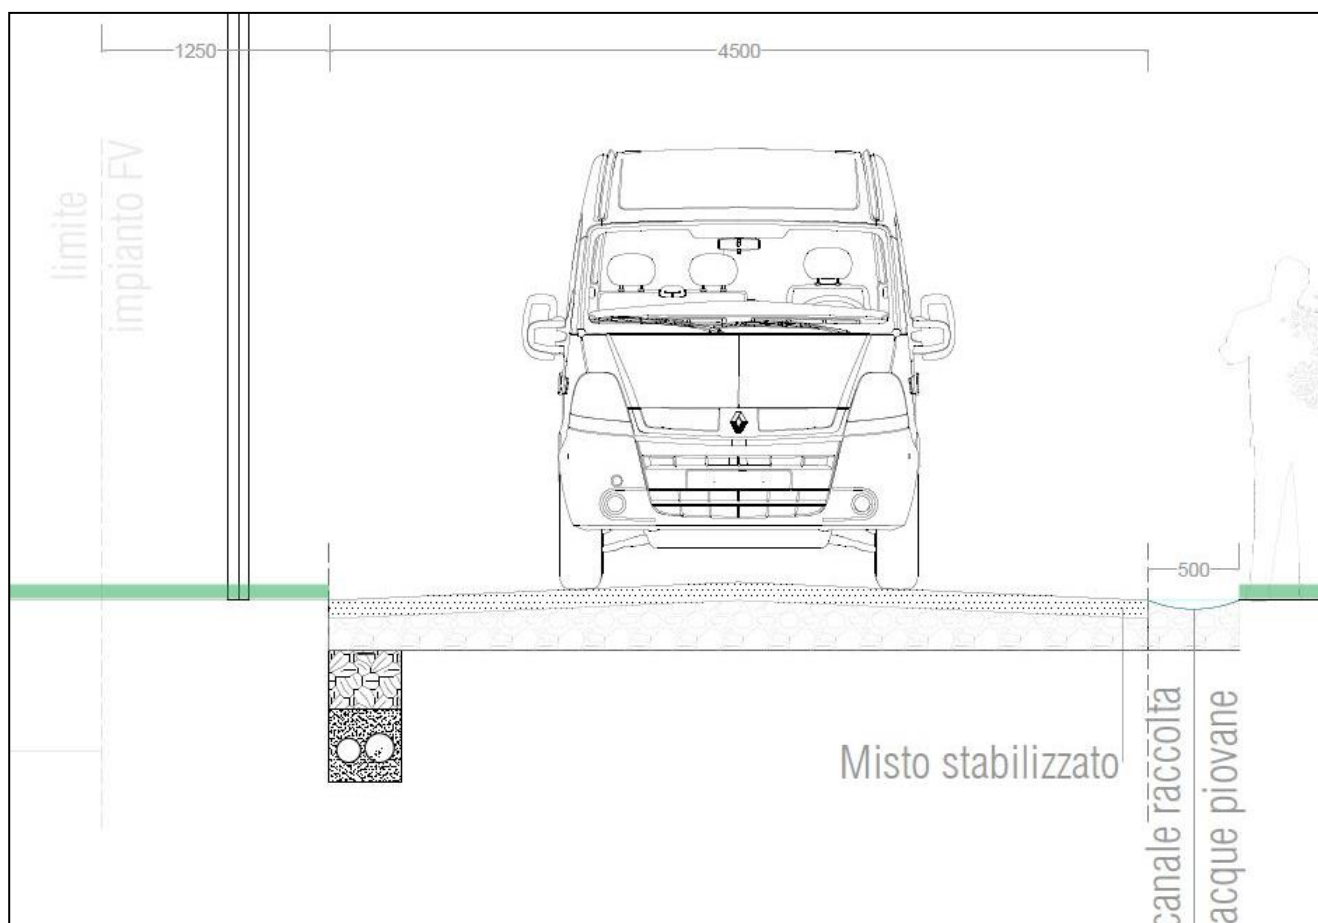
Sezione tipo della viabilità con cavidotto interrato
